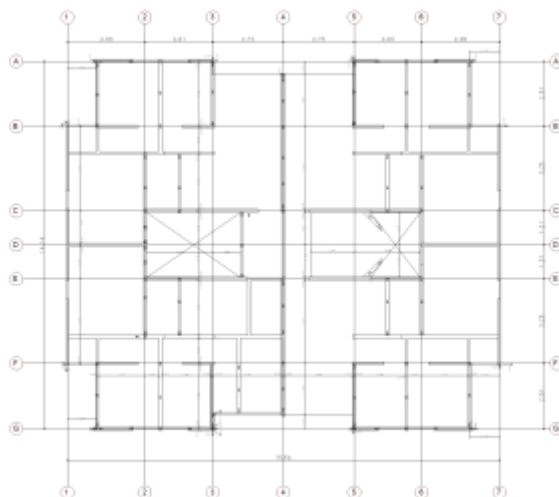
Planta arquitectónica edificación analizada (fuente propia)
